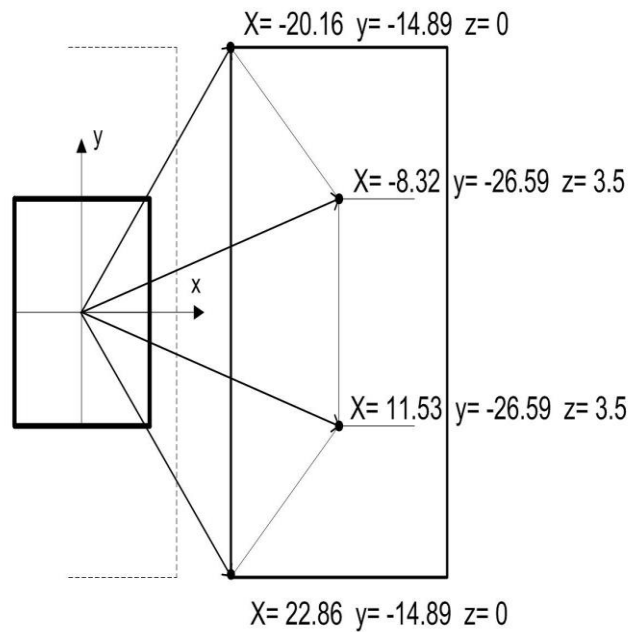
Vista en planta del área ocupada por captadores y el edificio 8 Citt
